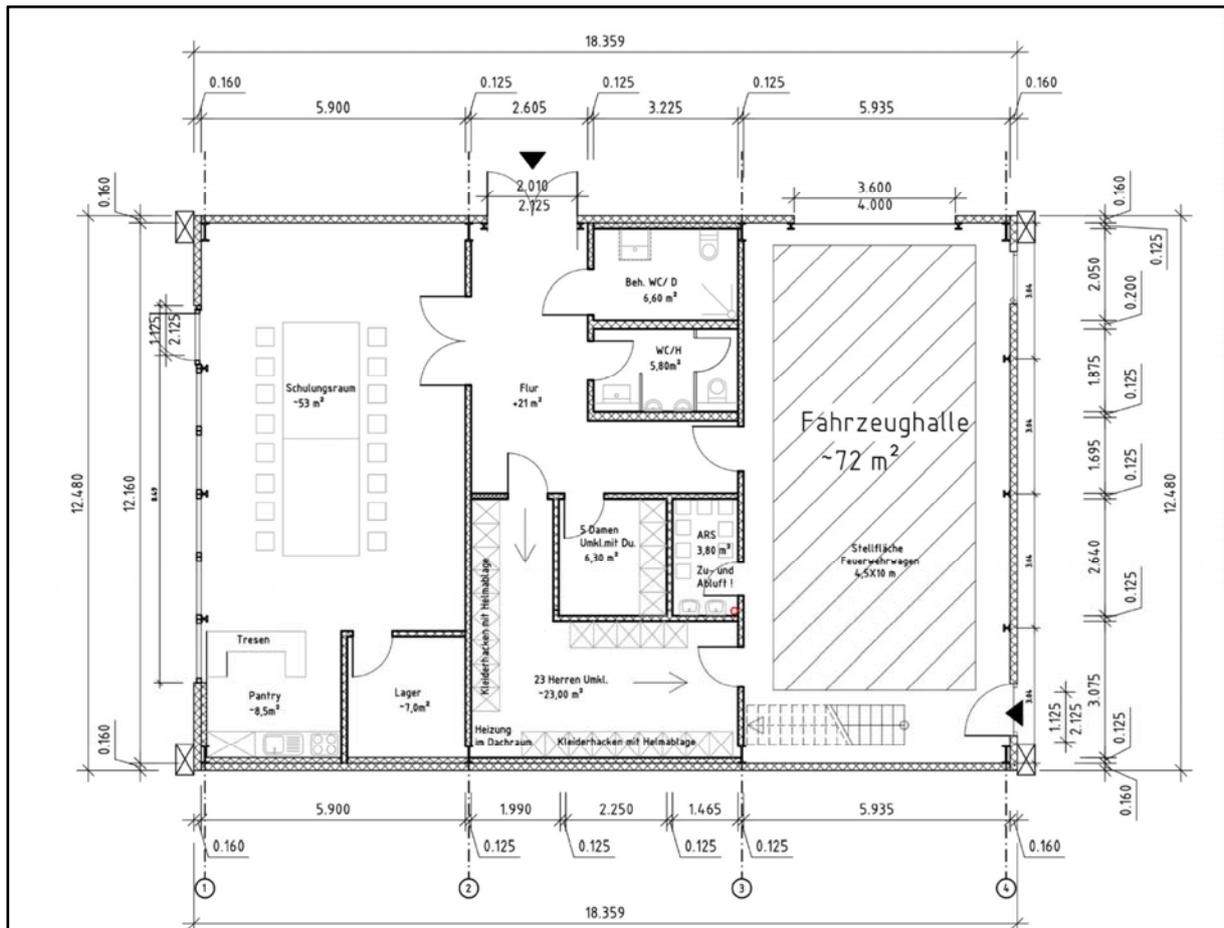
Grundriss des Feuerwehrgerätehauses (Architekturbüro Ladwig, Stand: Januar 2020)
